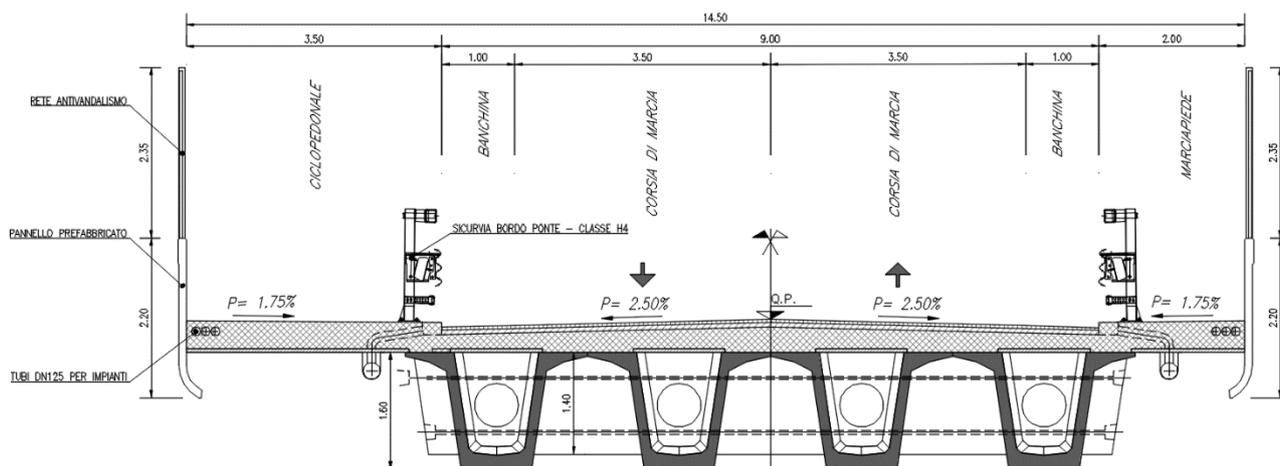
Sezione tipo di Progetto - cavalcaferrovia IV26 (L=30,00 m)
